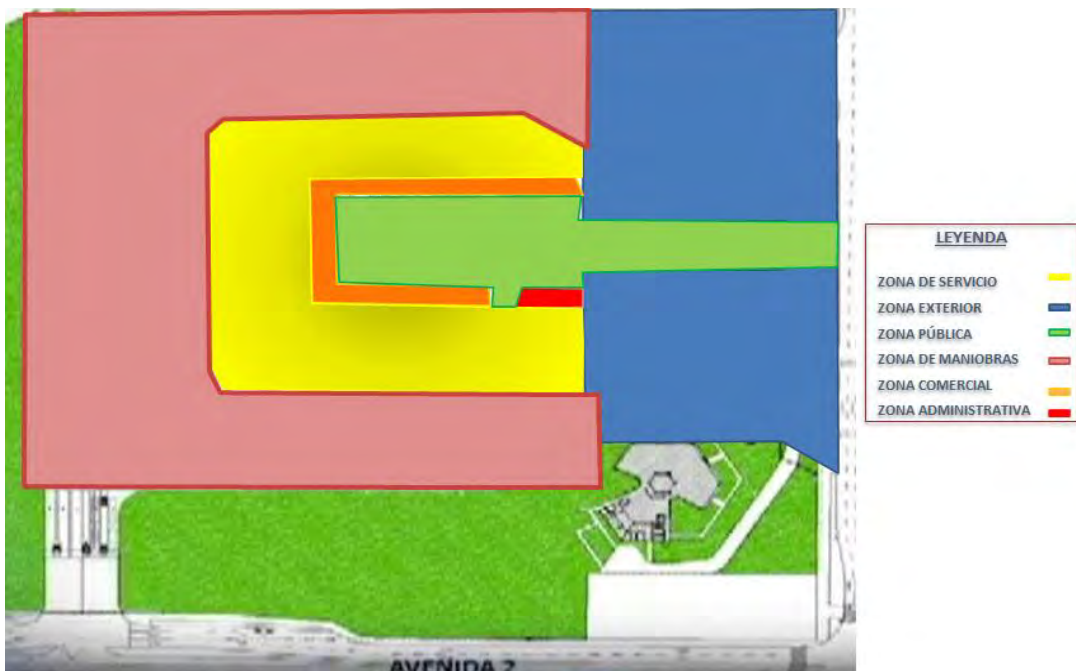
Plano de zonificación del Terminal Terrestre de Trujillo
